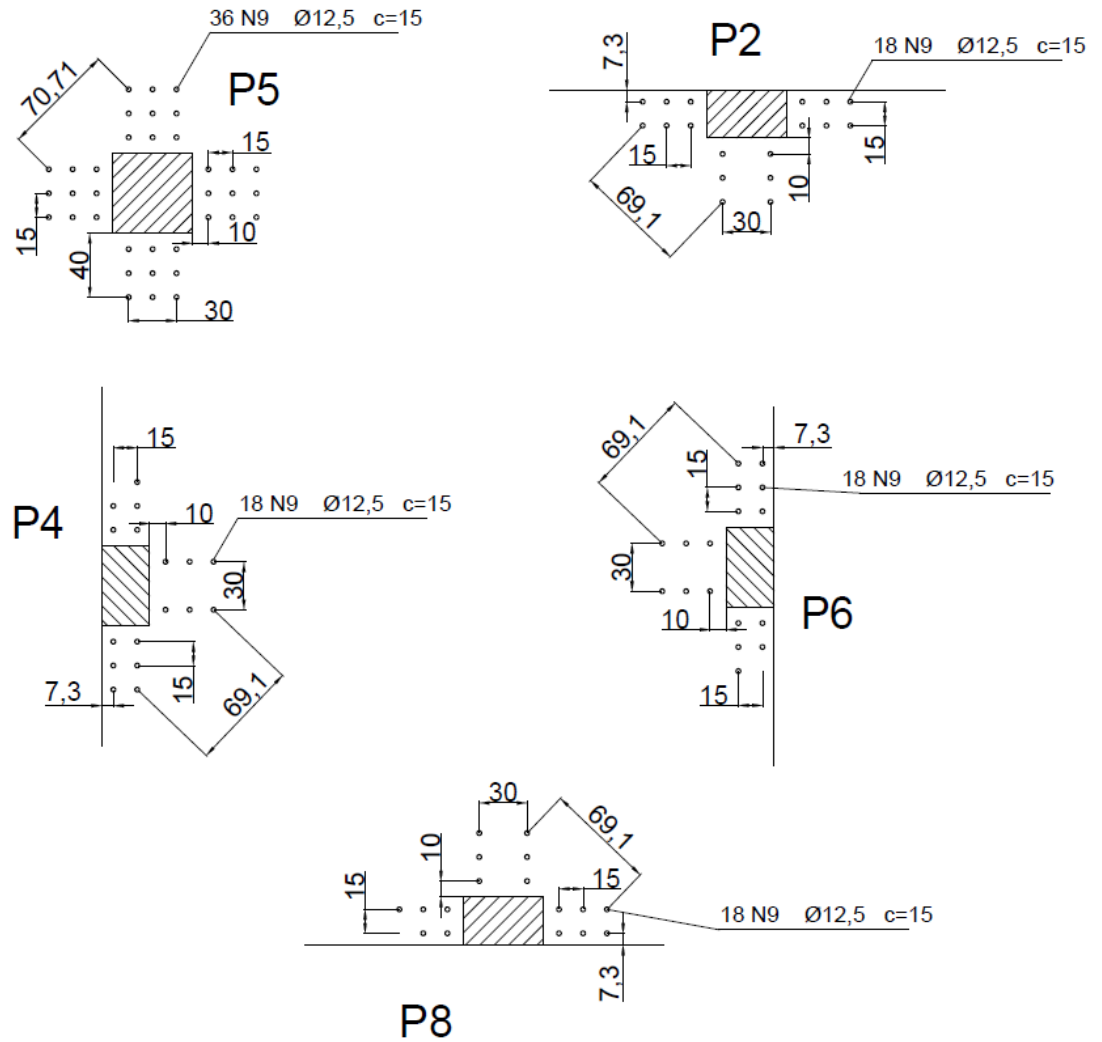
Detalhamento da armadura de punçoamento NBR 6118/2014
